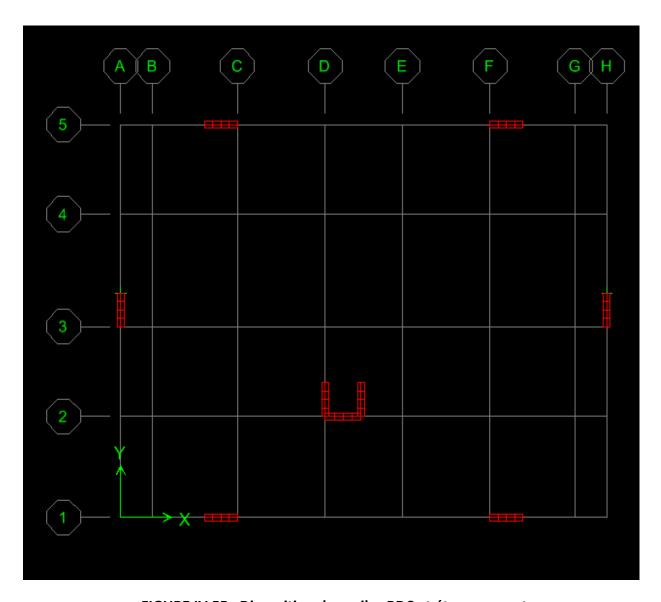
Disposition des voiles RDC et étage courant
